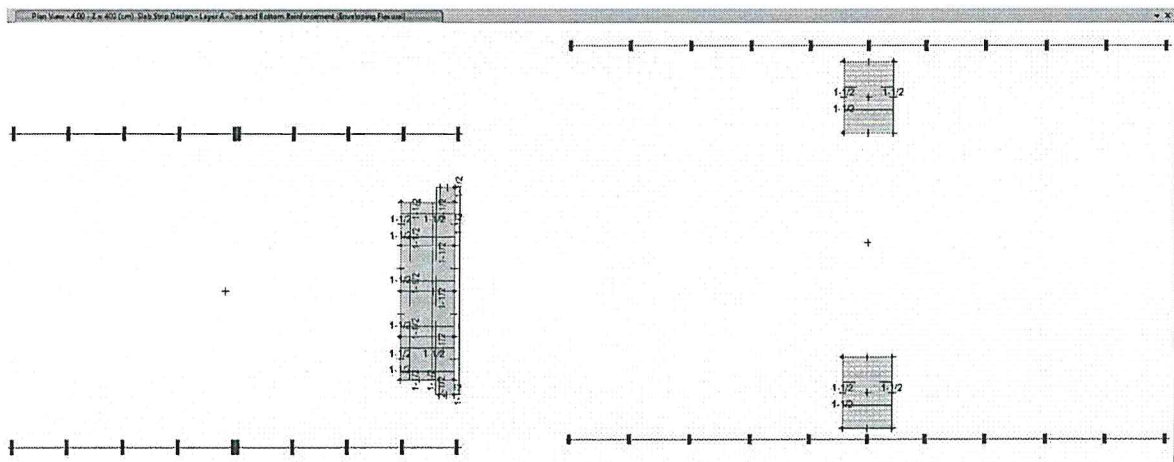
Vista en Planta - Edificación 19-20 - Diseño de Refuerzo Longitudinal y Transversal en Losas macizas y aligeradas, calculando el Área (As) en cm²; Calculado por el Programa ETABS Ultimate C 19.0.0.
